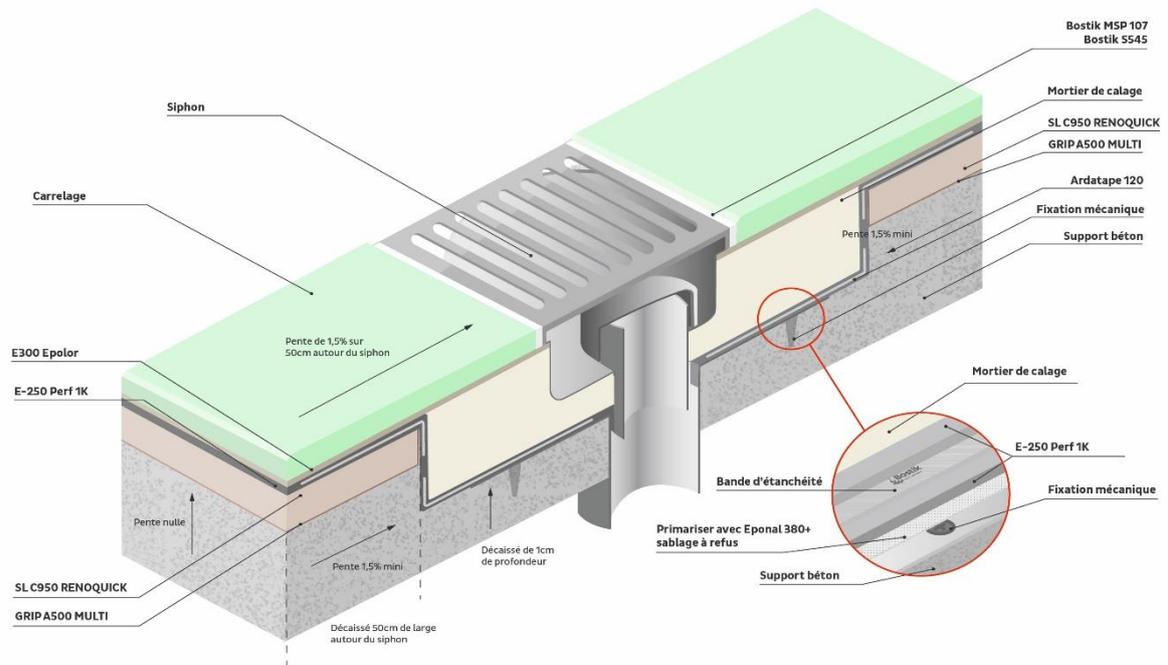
Raccordement à un caniveau - Cas d'une pose collée du carrelage
